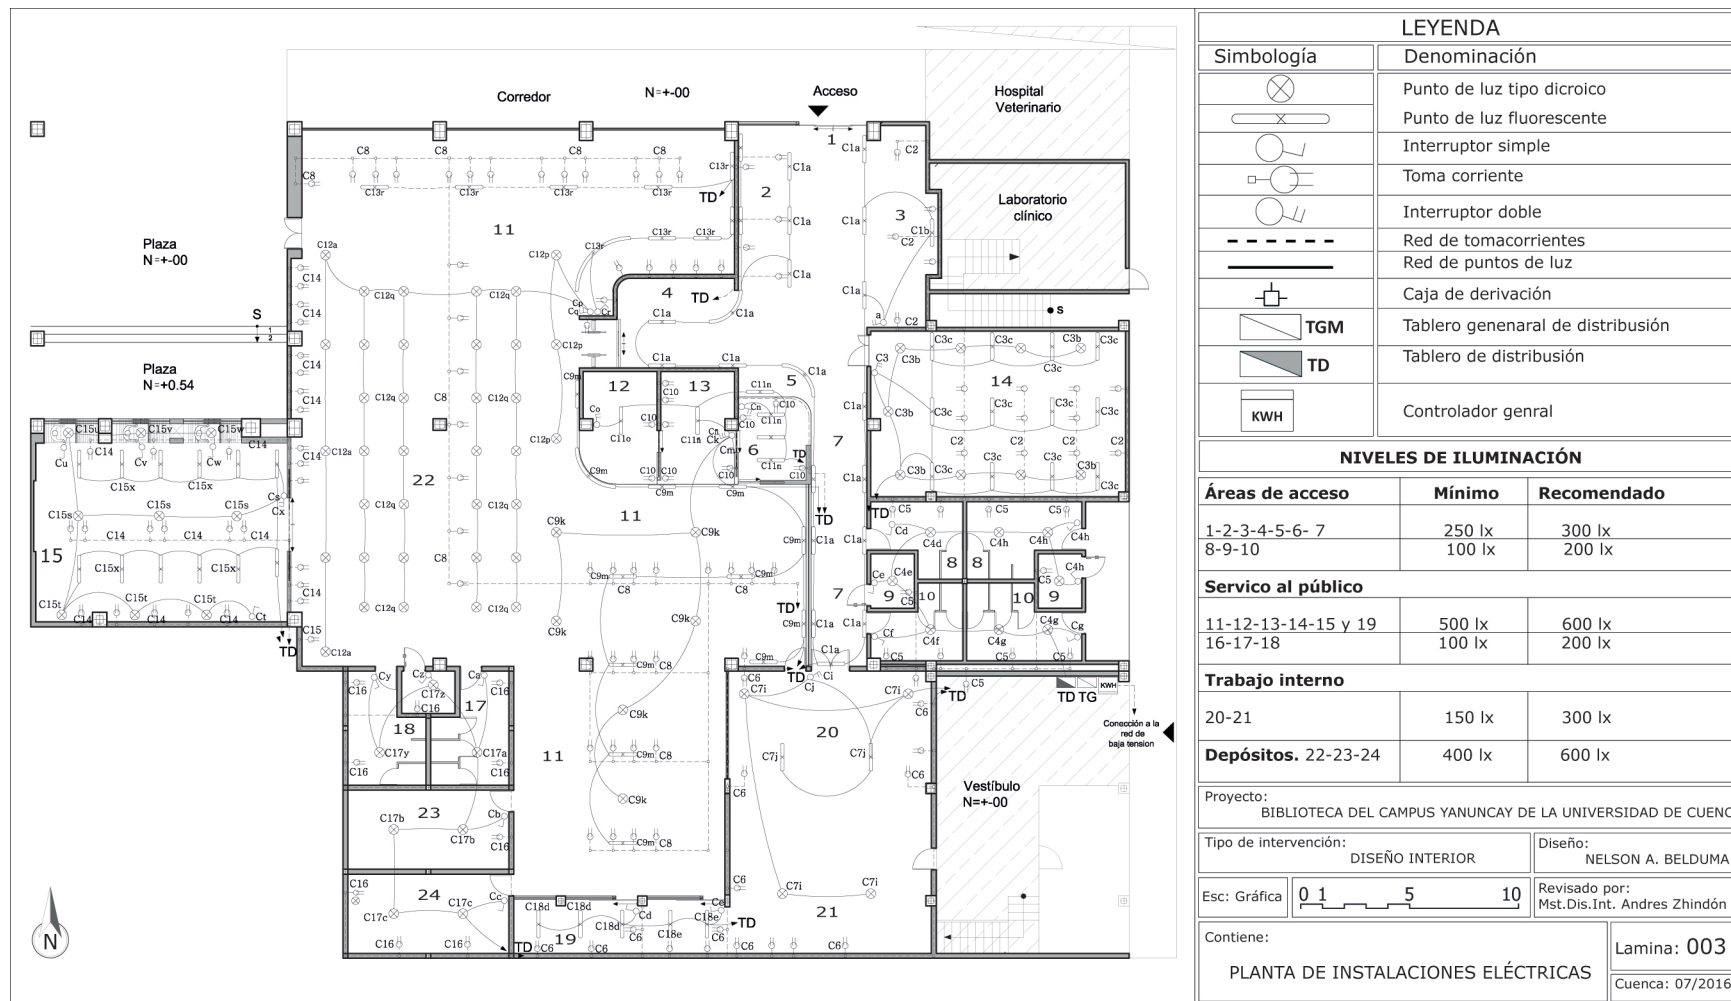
Planta de instalaciones eléctricas y niveles de iluminación.
